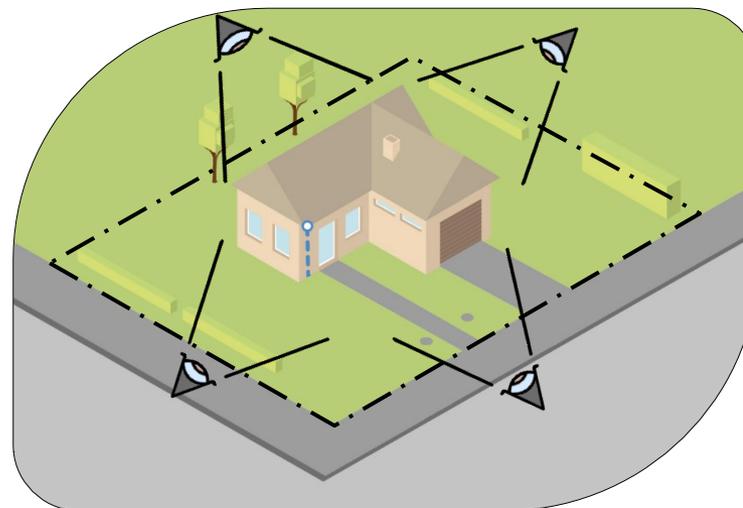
### PHOTOS DES INSTALLATIONS ET COMMENTAIRES
